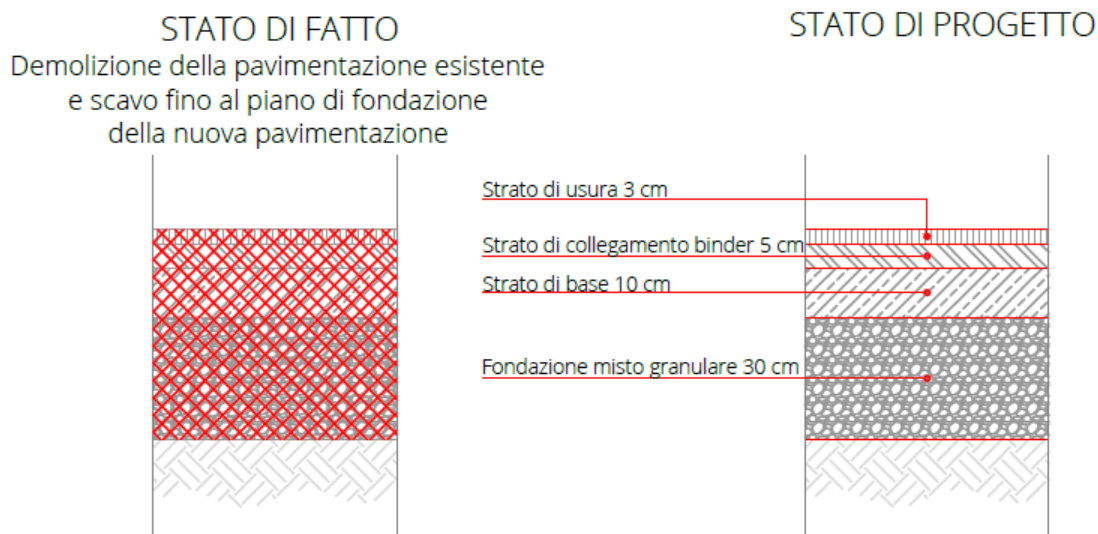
Rifacimento pavimentazione stradale - Tipo C
